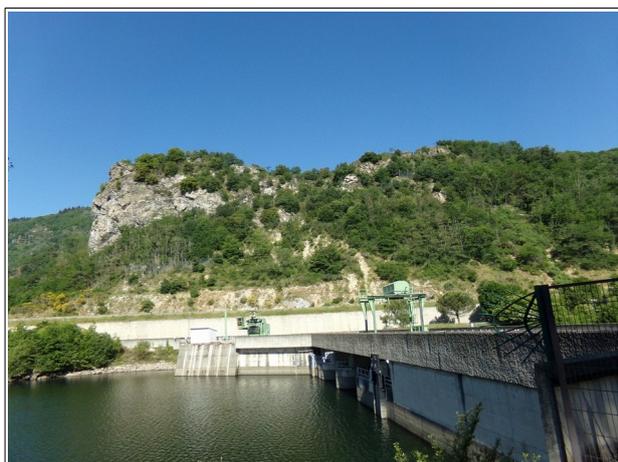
Barrage EDF de Garrabet construit à l'entrée d'une gorge.
